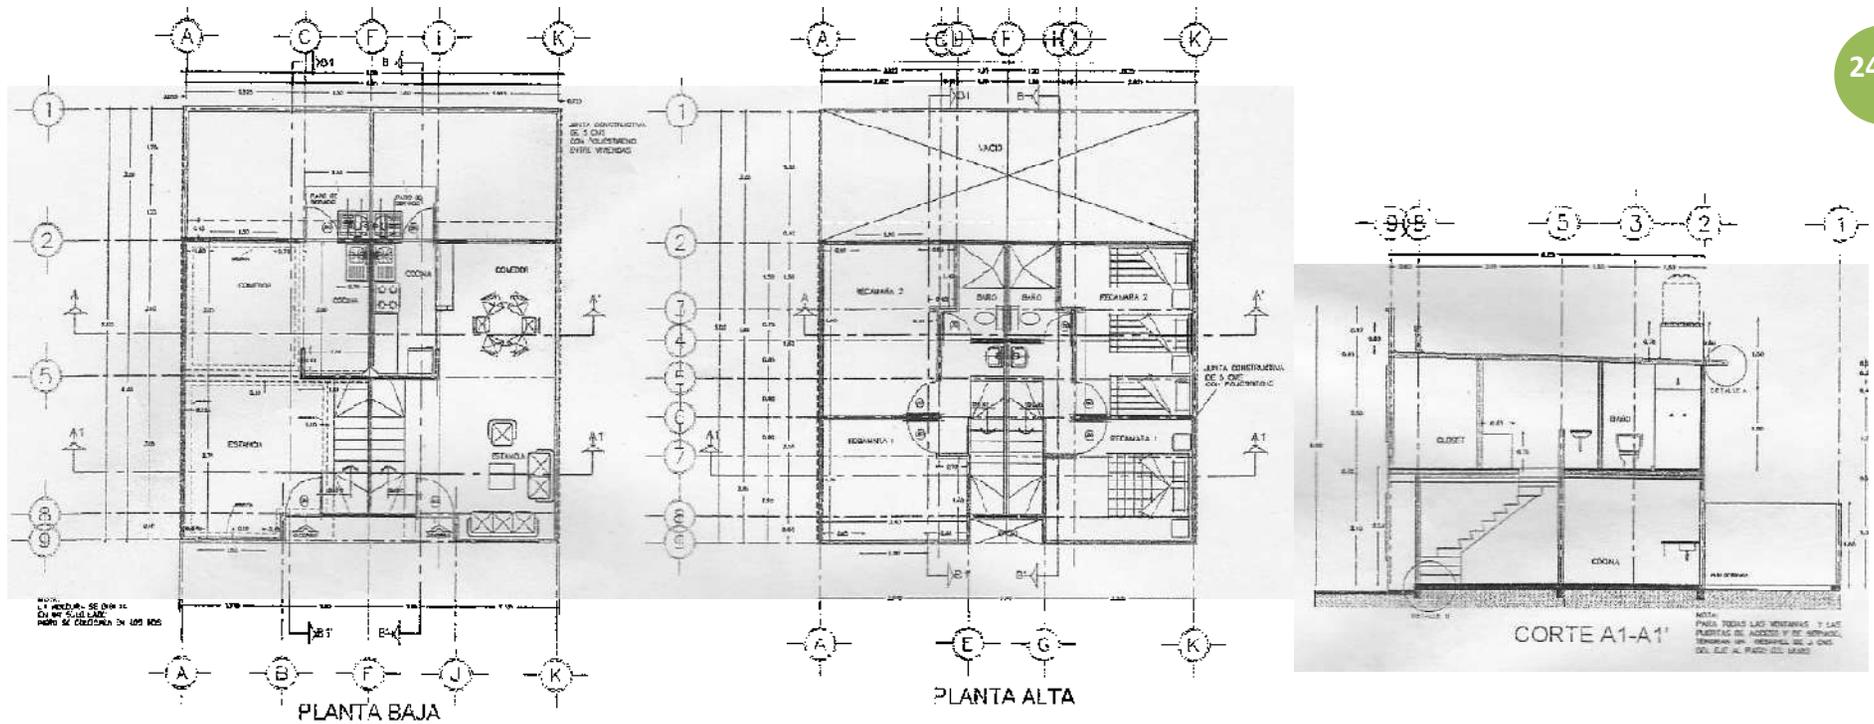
Plano arquitectónico de casa 2 plantas en condominio así como corte transversal, fraccionamiento Villas de la Loma
